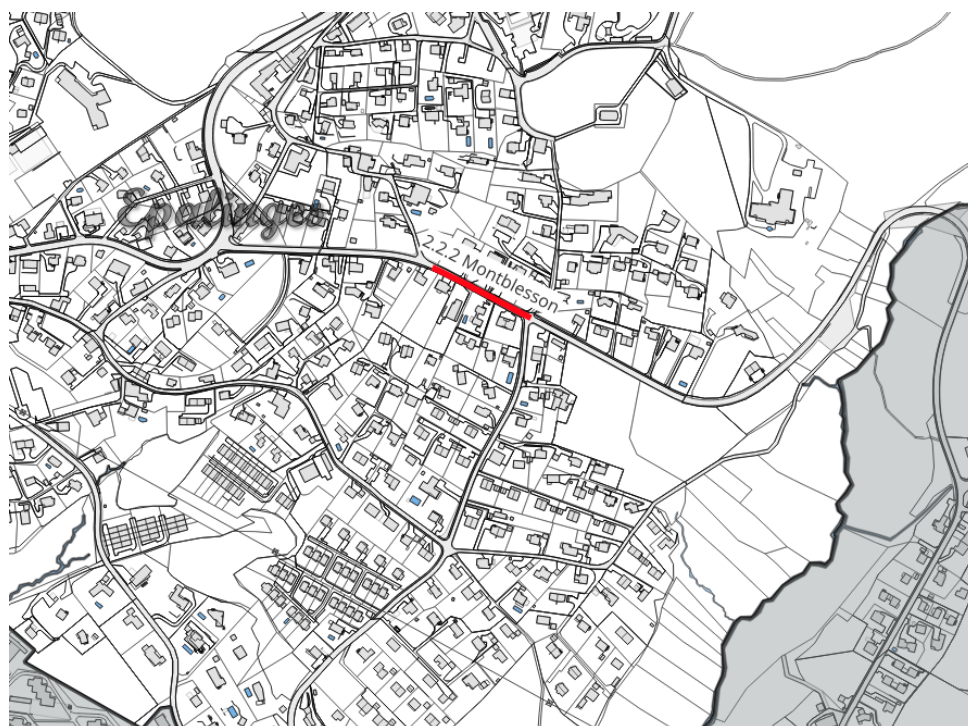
plan de situation avec les collecteurs faisant l'objet du présent préavis.
